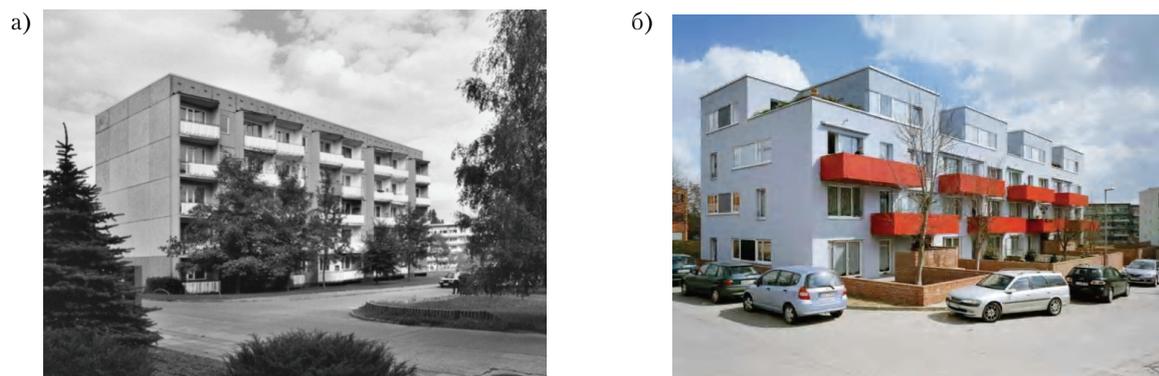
Панельный дом в г. Лайнефельде, Германия (а – до реконструкции, б – вид дома после реконструкции).
